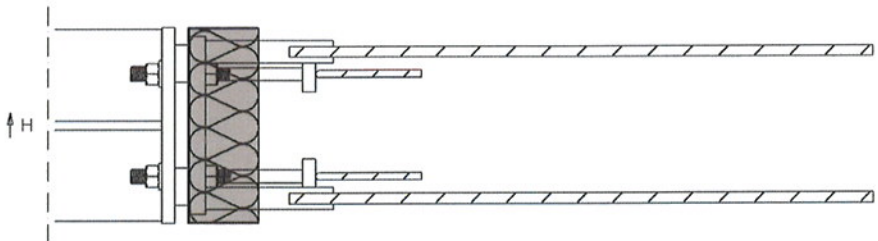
Grundriss Isopro Typ SBQ8, SBQ10 und SBQ12
